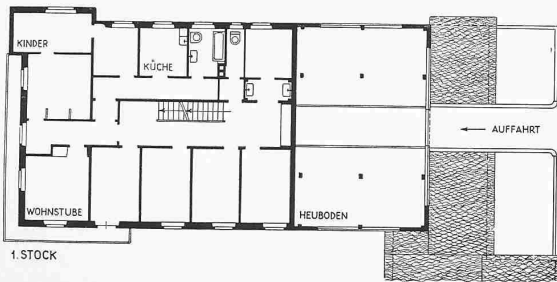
bis 28. Oekonomie, Grundrisse 1:400
